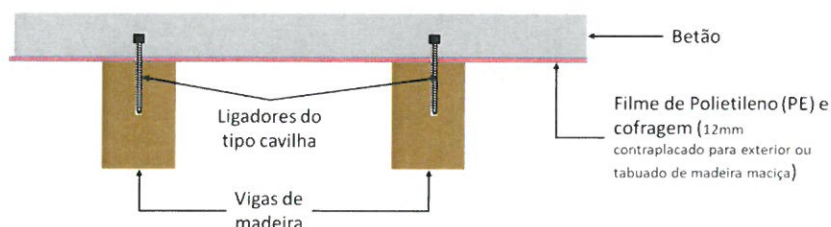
Elemento estrutural compósito madeira-betão produzido por ligadores do tipo cavilha – EAD nº 130090-00-0303
